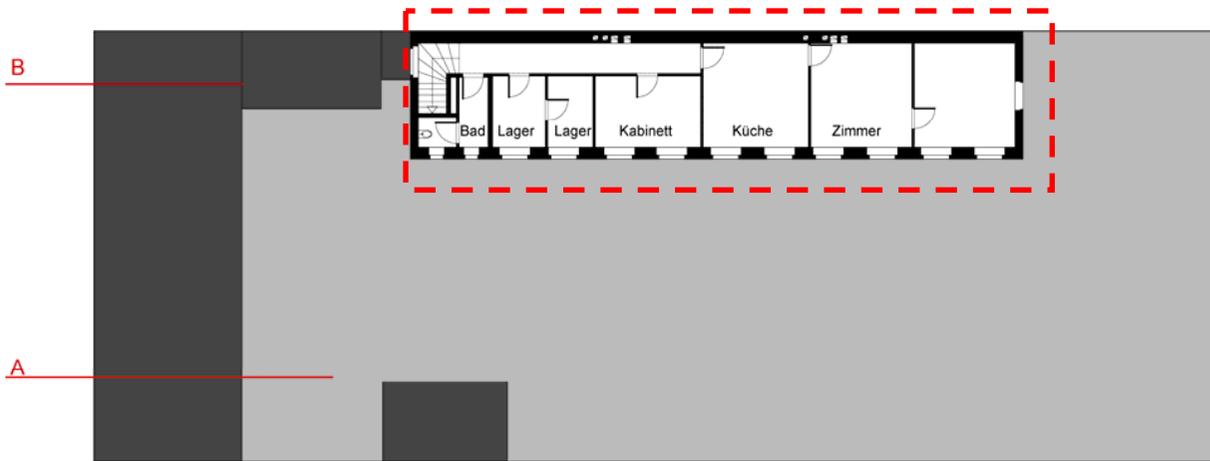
Grundriss erstes Obergeschoss mit der neu eingebauten Wohneinheit
